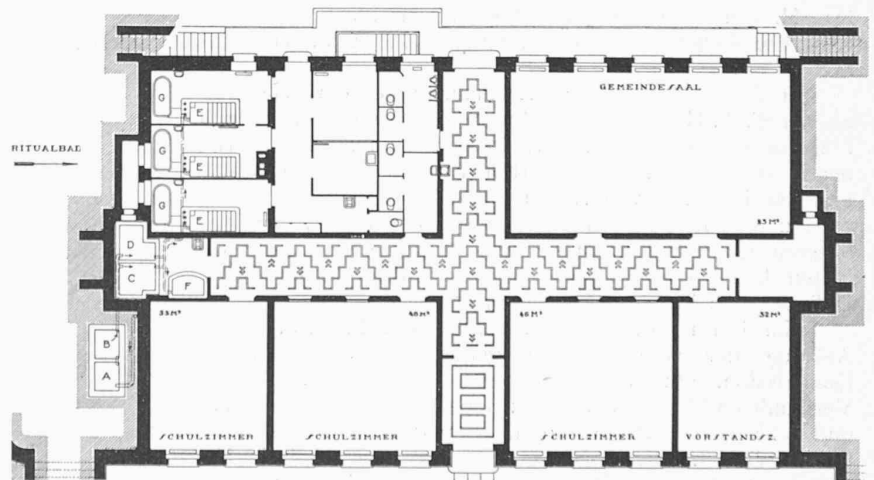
Grundriss vom Untergeschoss. — Masstab 1 : 300.
